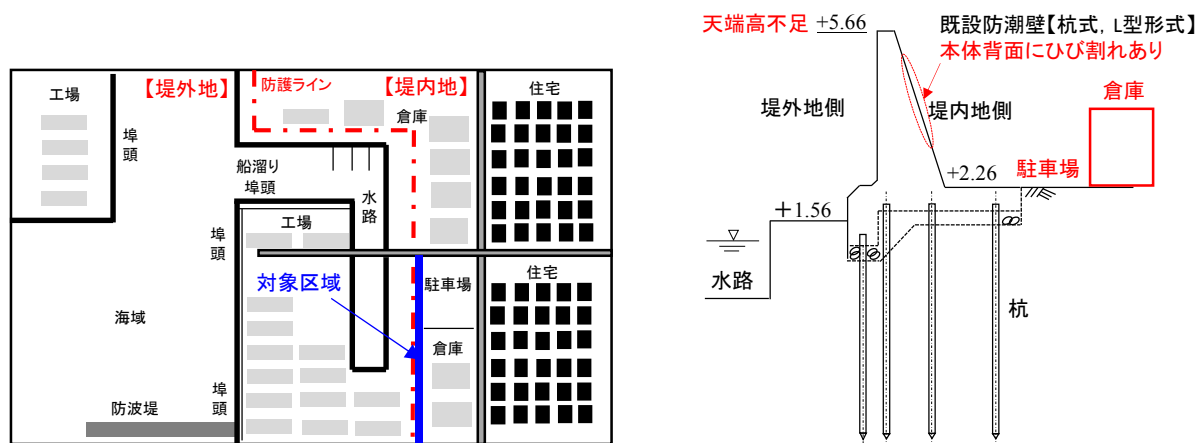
改良・補修対象とした防潮堤の平面位置図と断面図
